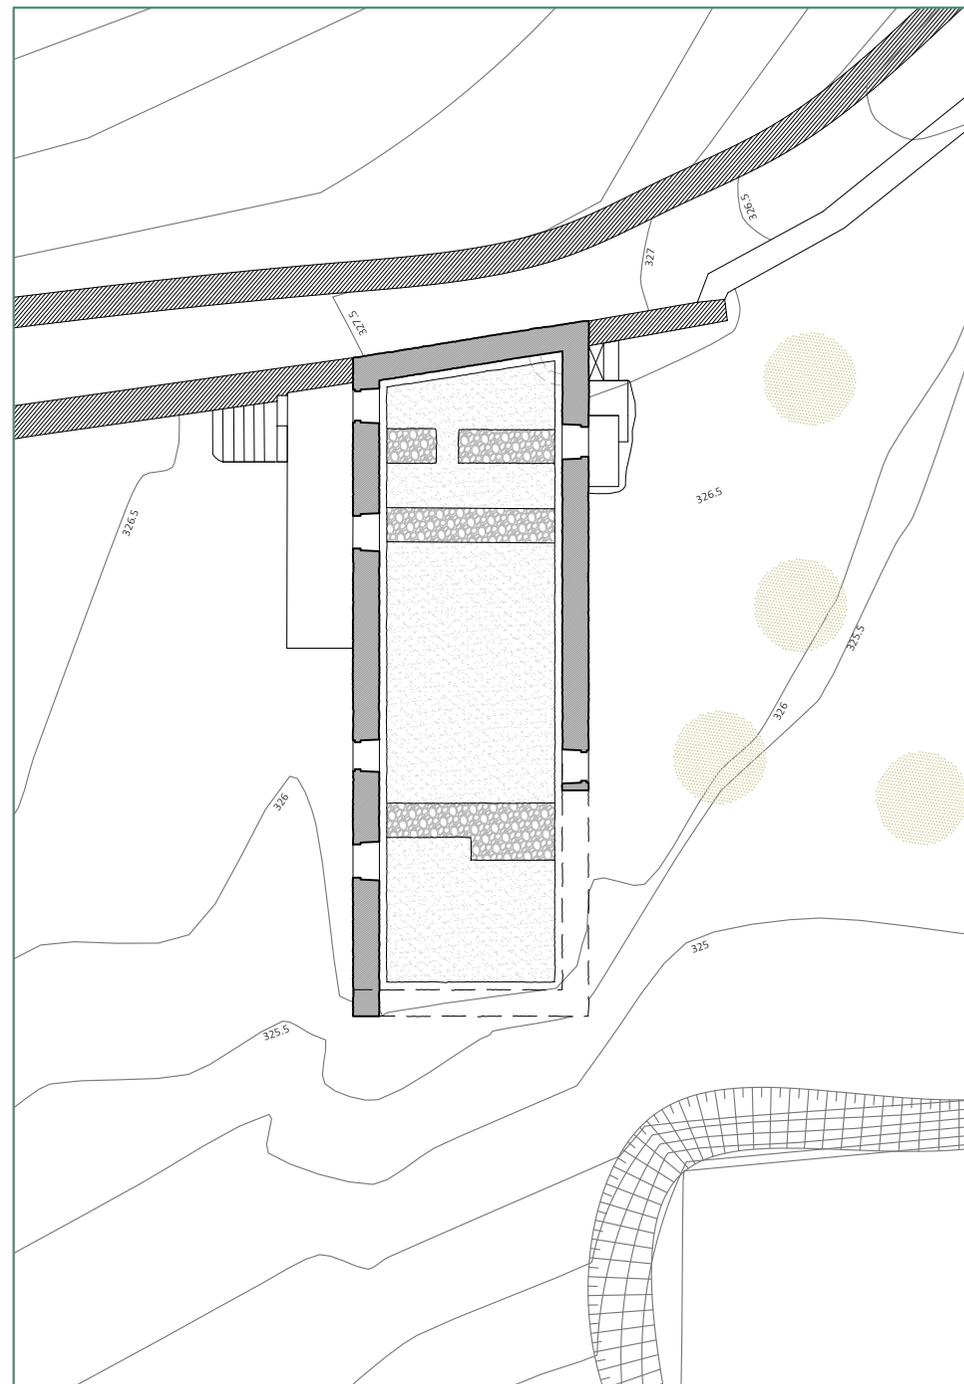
Planta alta ruinas vivienda (Elaboración propia)
